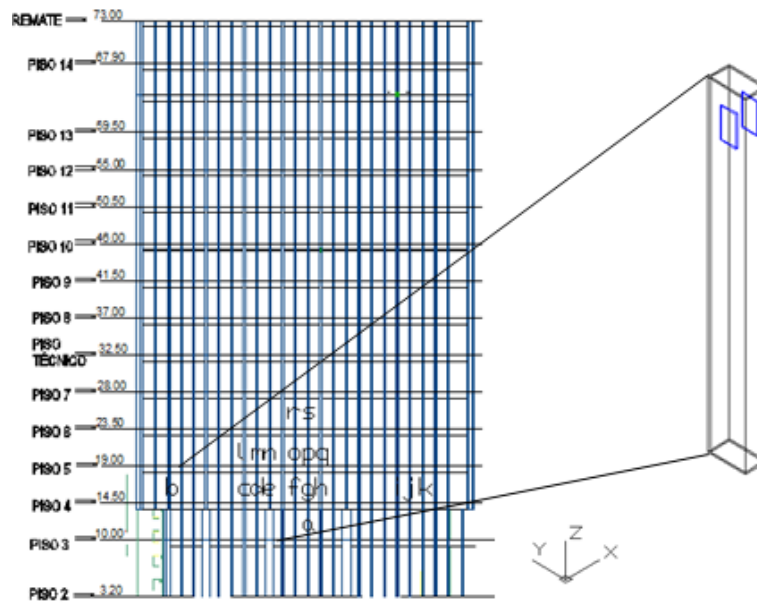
Ubicación galgas extensométricas en Col Facha de 6 mm costado frontal de la estructura
